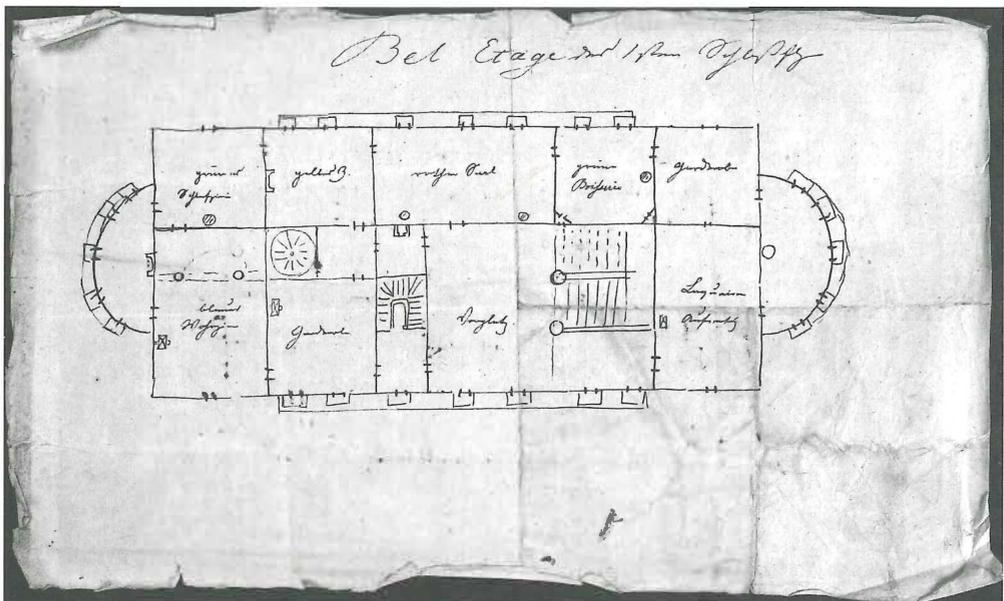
Schloss Wilhelmshöhe, Weissensteinflügel, Grundriss-Skizze, Bel Etage, um 1825. aus: StA MR, Best. 7 b 2, Nr. 144, Aufnahme: Barbara Krippner 2007
